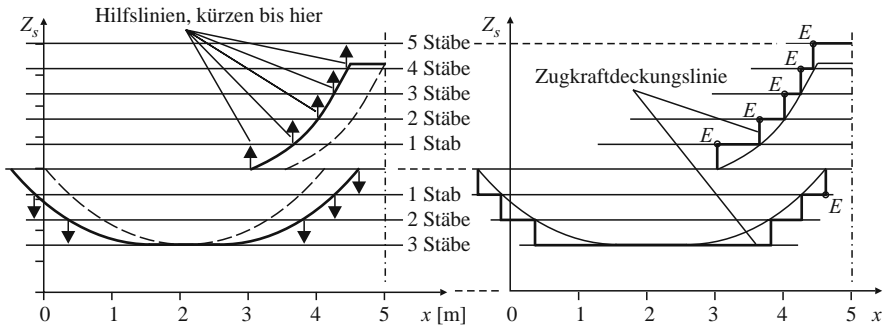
Vorgehensweise bei der Ermittlung der abgestuften Bewehrung
